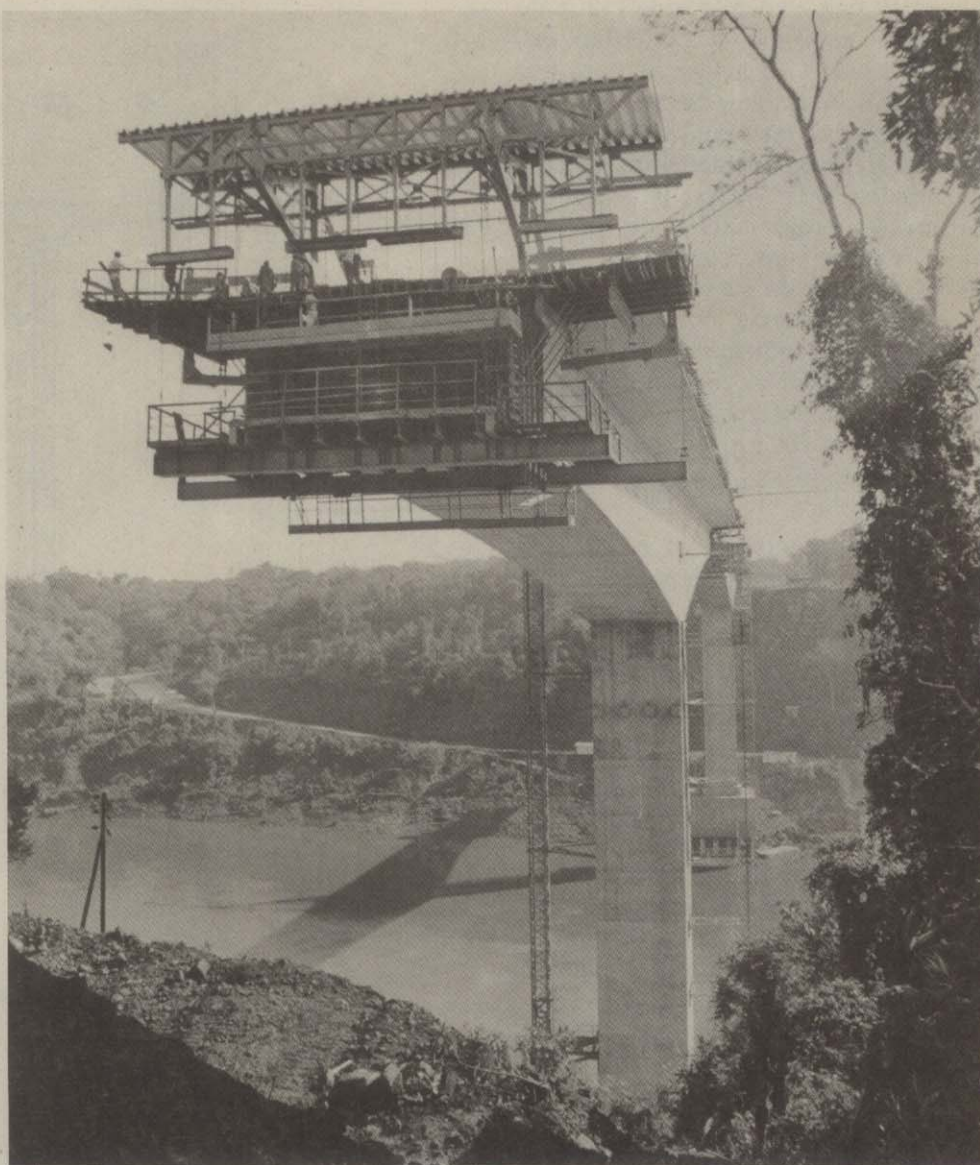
Construcción de la superestructura por avance en voladizos sucesivos.
